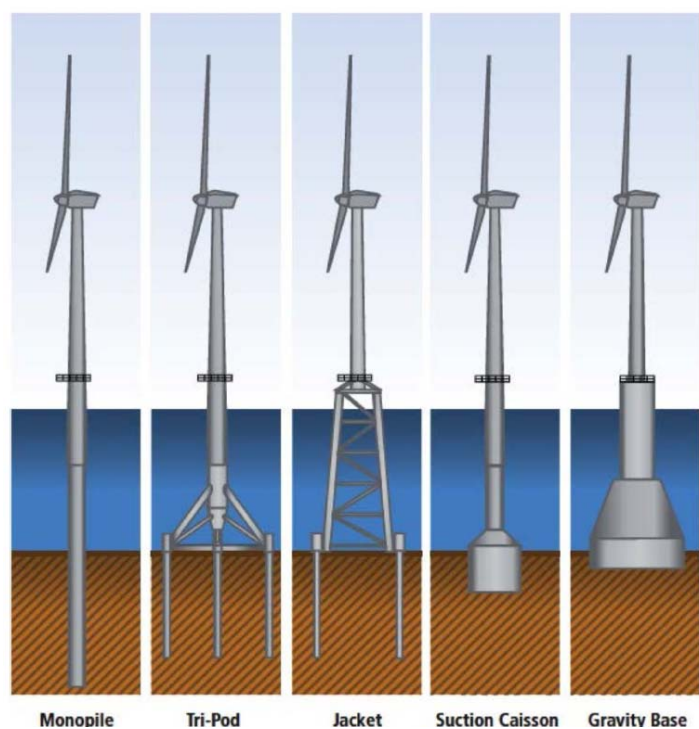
支持構造形式の代表例 (Navigant, 2013)
